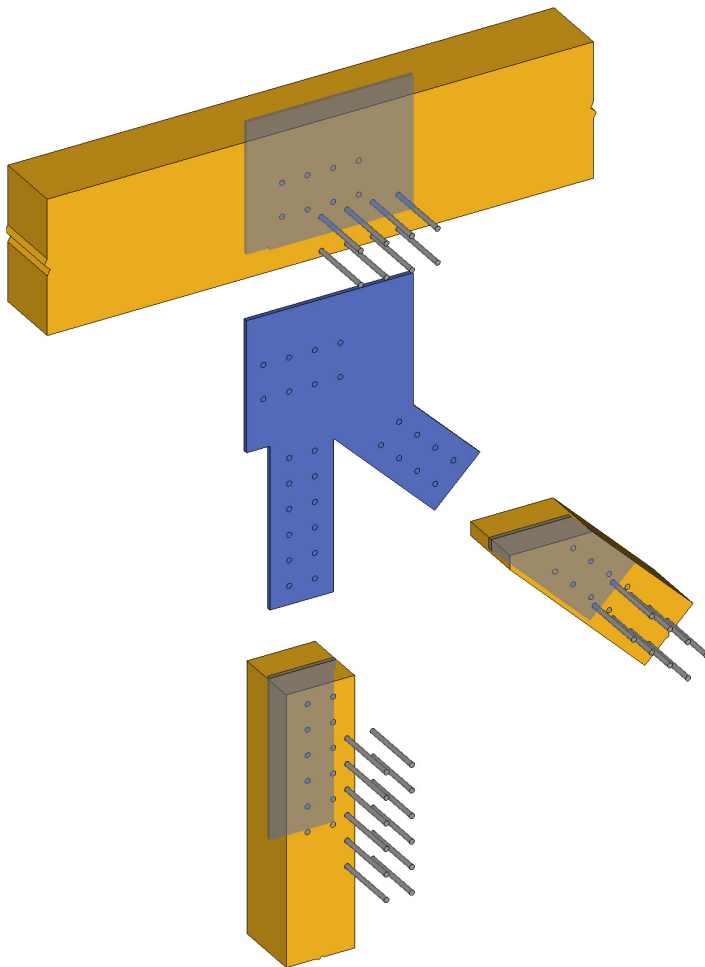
Explosionszeichnung des Anschlusses für Fachwerk FA1.j
